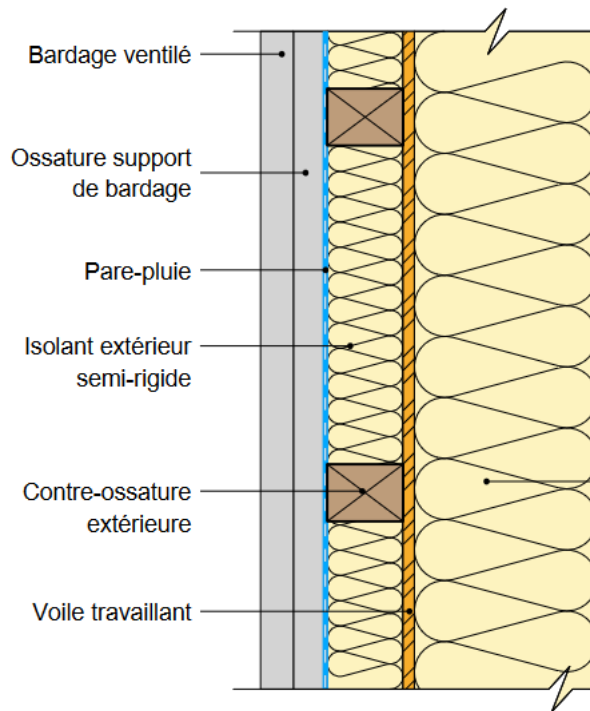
Paroi à ossature bois avec isolation entre montants et complément d'isolation par l'extérieur avec système pare-pluie ou de protection à l'eau souple sur support continu (coupe verticale)
